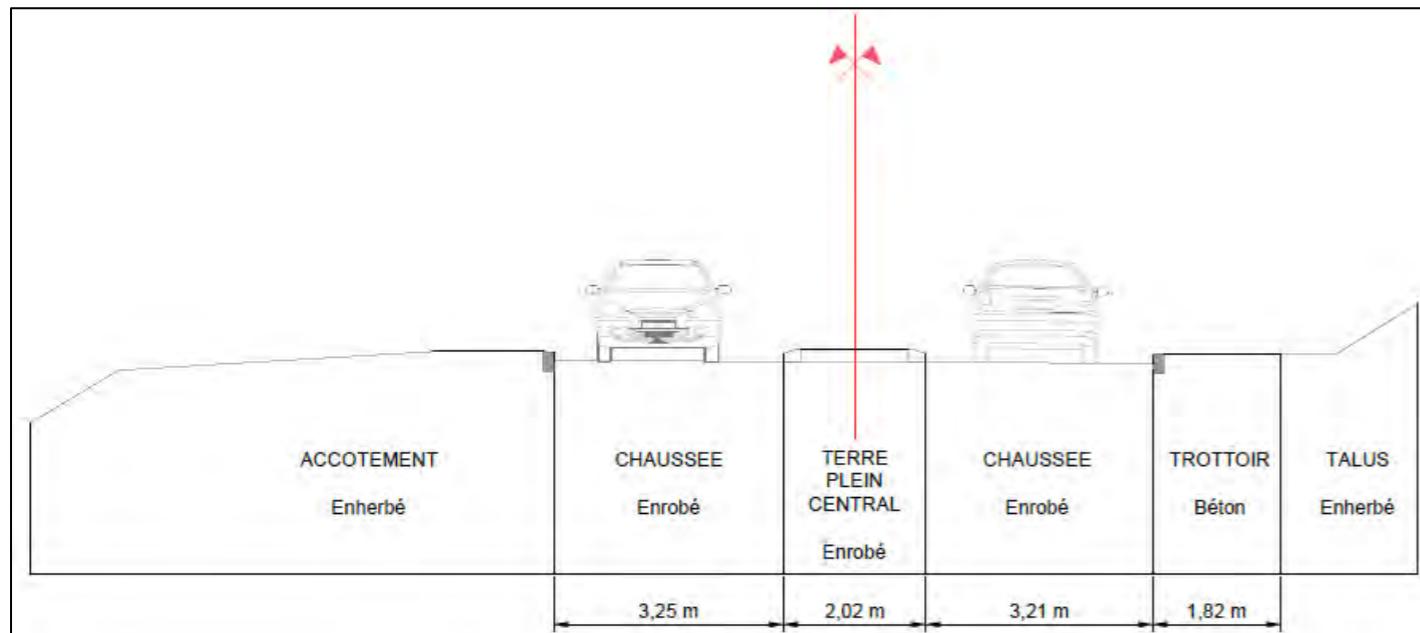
Avenue de la Prairie – Allée des Sports- Profil en travers existant - Setec / Signes-Paysages
